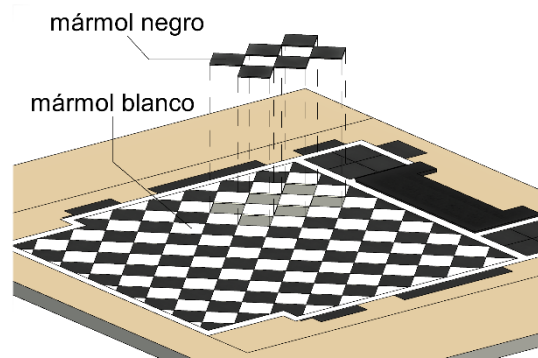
Pavimento dividido en cada una de sus partes con etiquetas de material. Fuente: elaboración propia.
